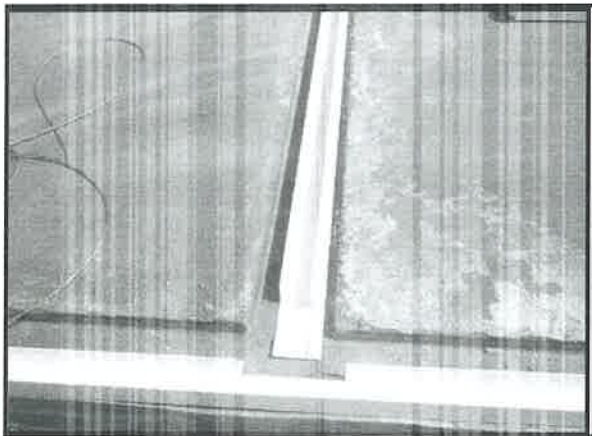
Perfil em PVC para fixação parede com a fundação.
